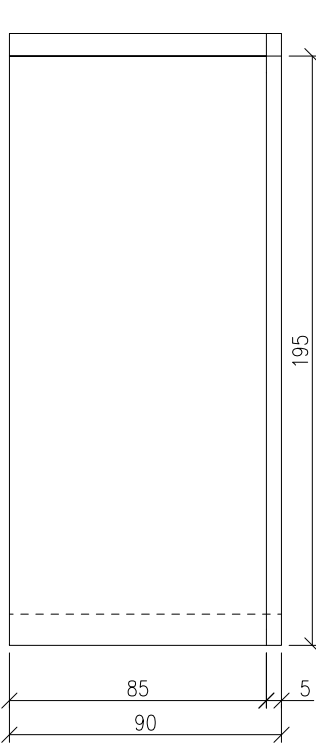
DETAIL SETKÁNÍ MADEL NA MEZIPODESTĚ
